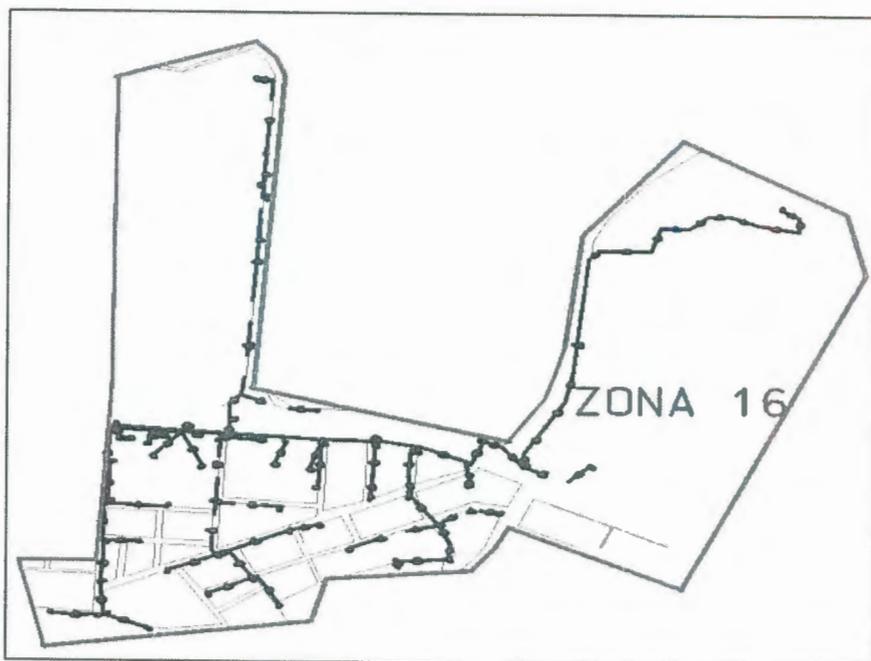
Planimetría zona 16 del sector de la vía a Daule
